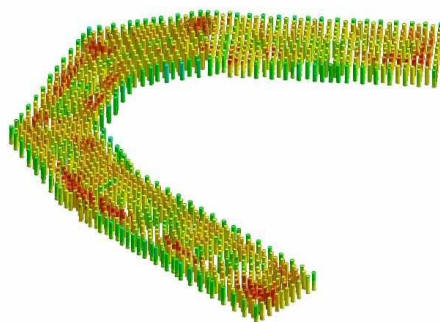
3D вид расположения грунтоцементных колонн под фундаментной плитой
